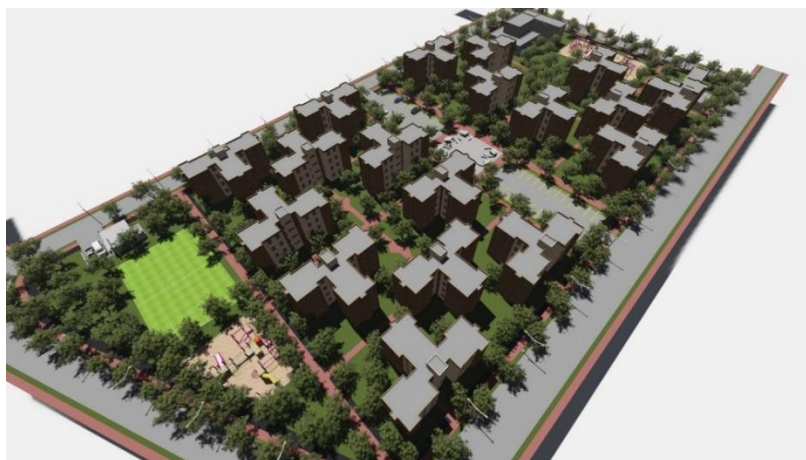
Estética urbana y arquitectónica del modelo en altura.
